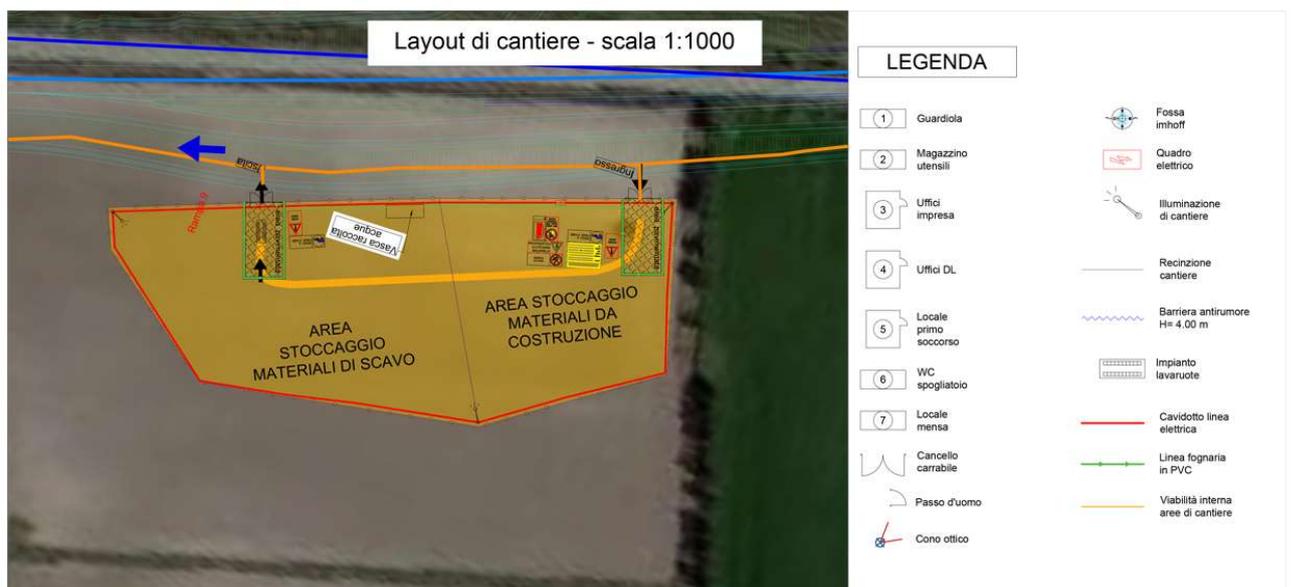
Stralcio planimetrico AS3 Area di stoccaggio 3
